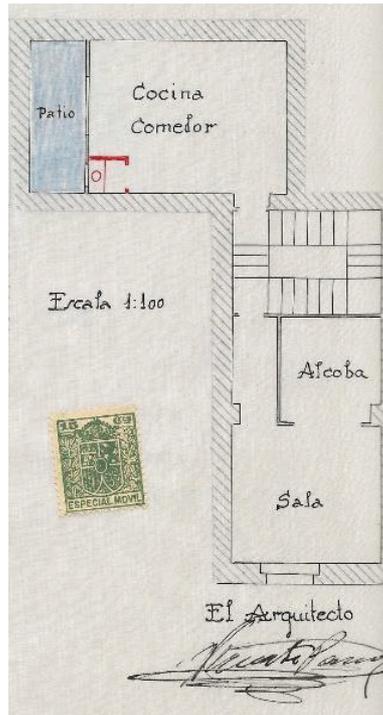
Planta de casa de dos claus de tres habitaciones, ancho de fachada 3,60 mts.²³
